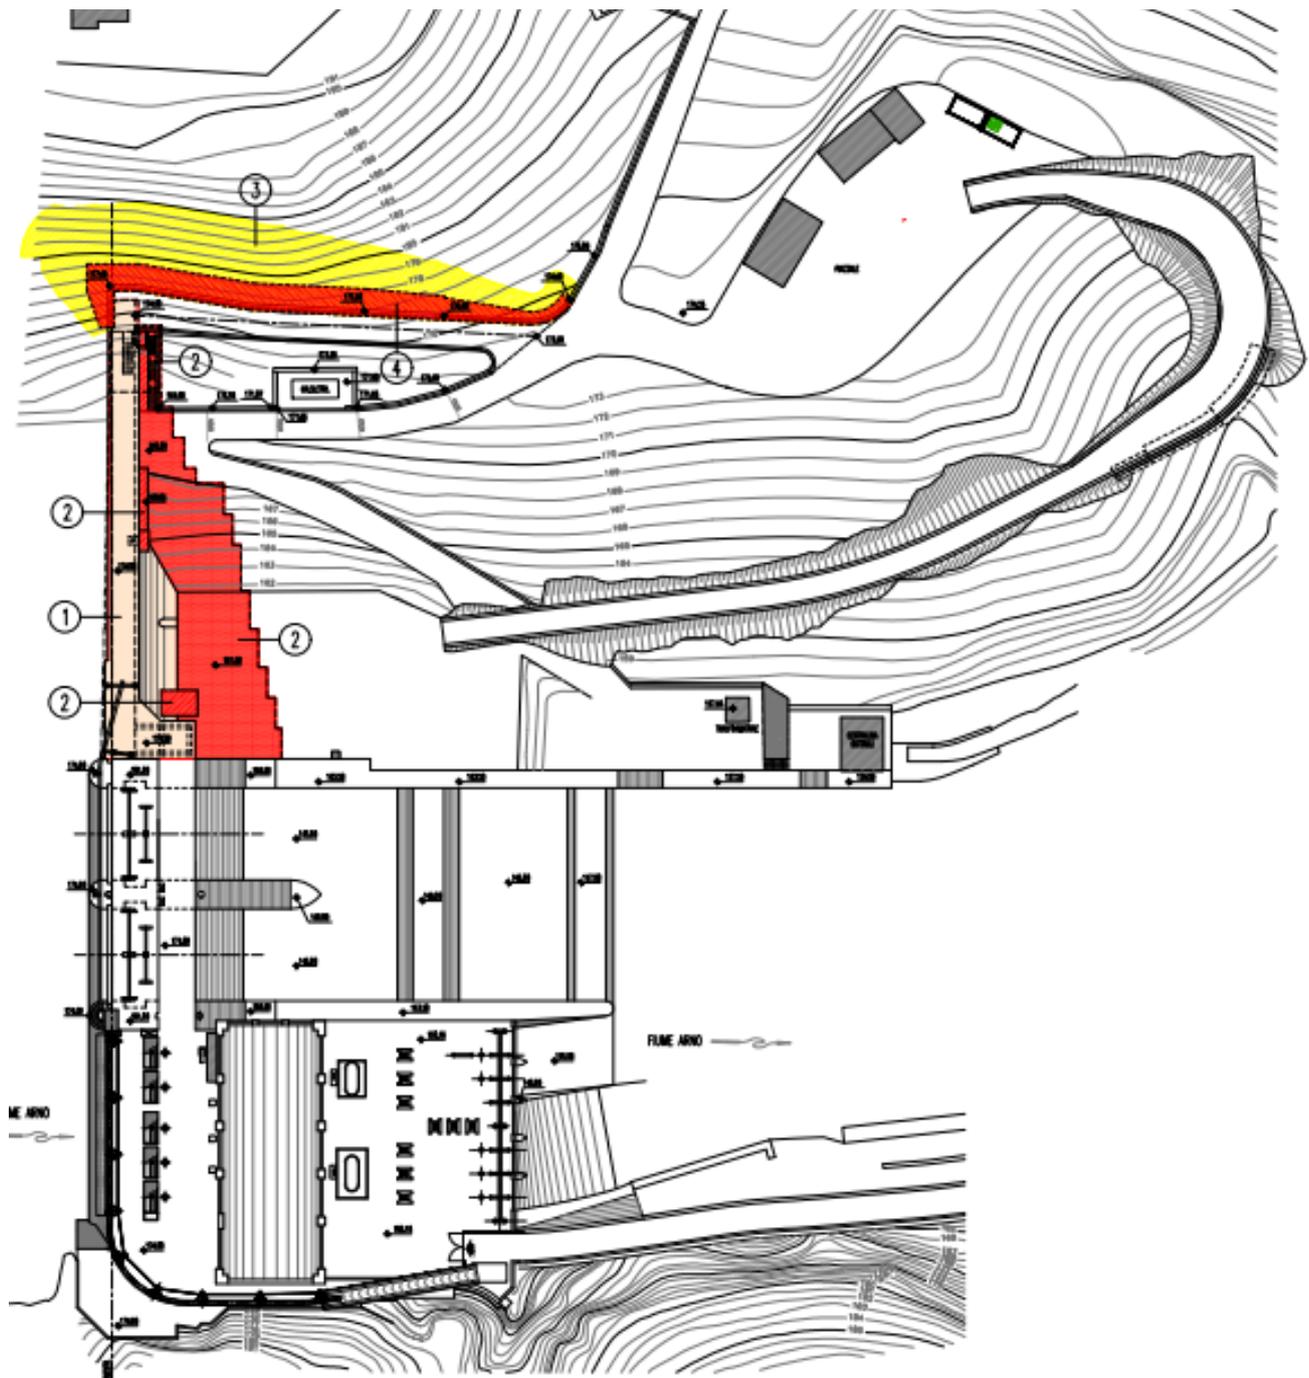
5 – Estratto planimetrico elaborato progettuale – Cantierizzazione FASE 4b
